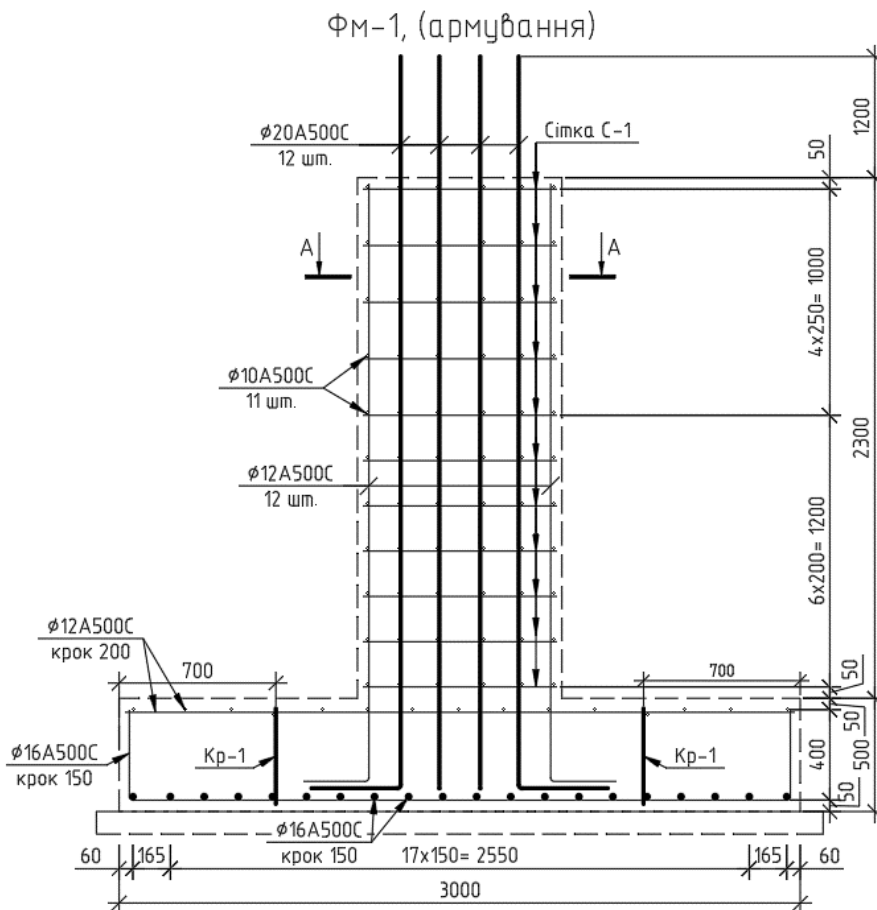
Армування центрального стовбчастого фундаменту
